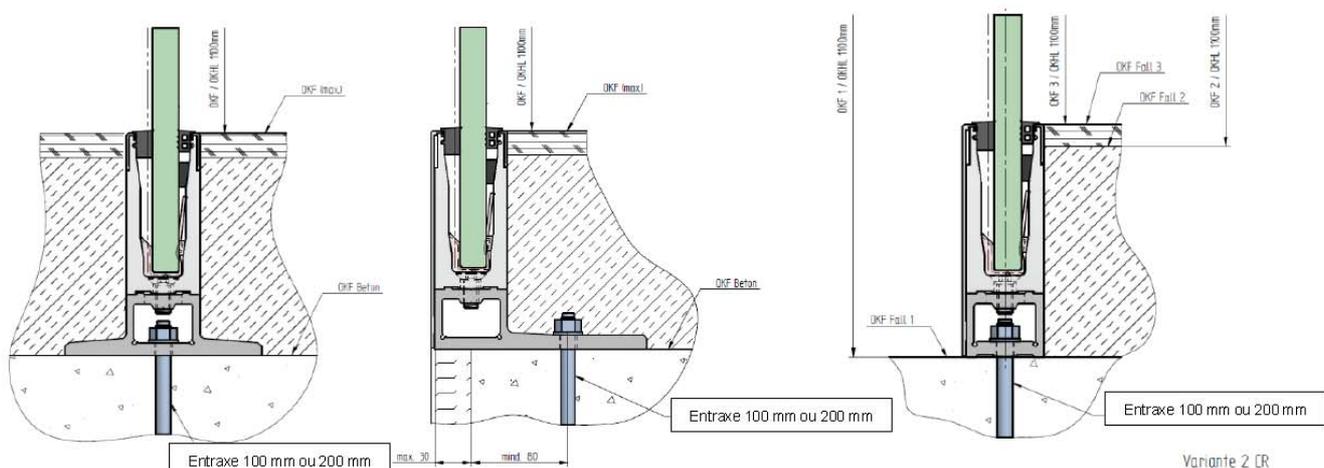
CROSILUX 2.0 – Montage sur dalle, surélevé sur profilé métallique de support
